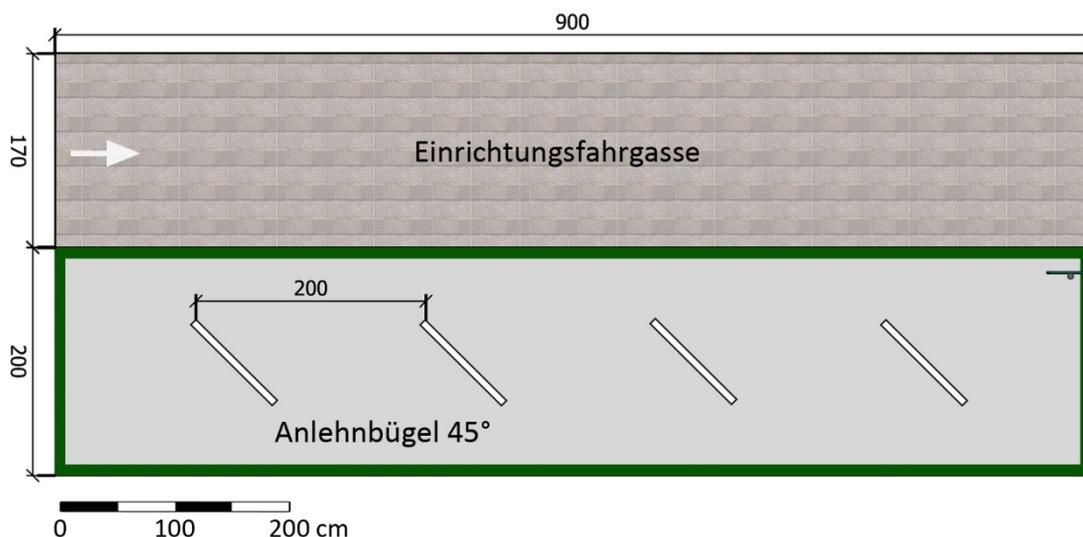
Grundrissdarstellung Variante 1: „Mindestausstattung“; Quelle: eigene Darstellung
